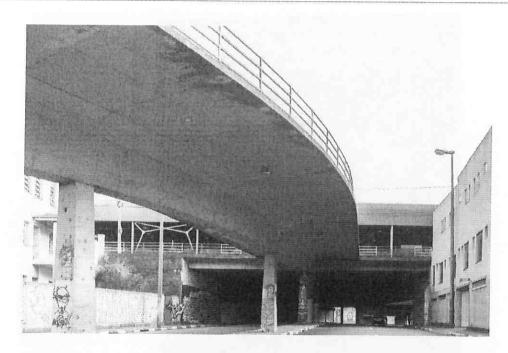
Vista da face inferior da estrutura (pilar+viga de travamento+laje) da passarela apresentando armadura exposta na viga de travamento e na laje, eflorescência na laje e na viga, infiltração vinda da rachadura na face superior do tabuleiro e mofo nos pilares
